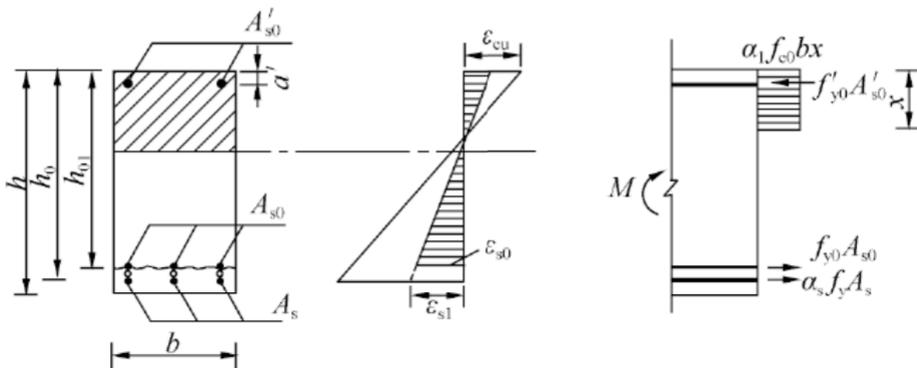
矩形截面受弯构件正截面加固计算简图
